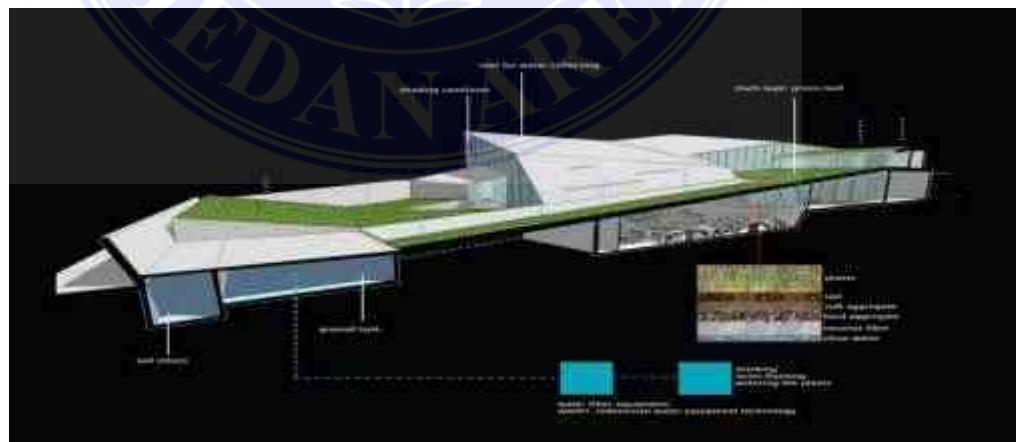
Bangunan Kantor Trafacon Office Building, Jakarta Tampak Atas
